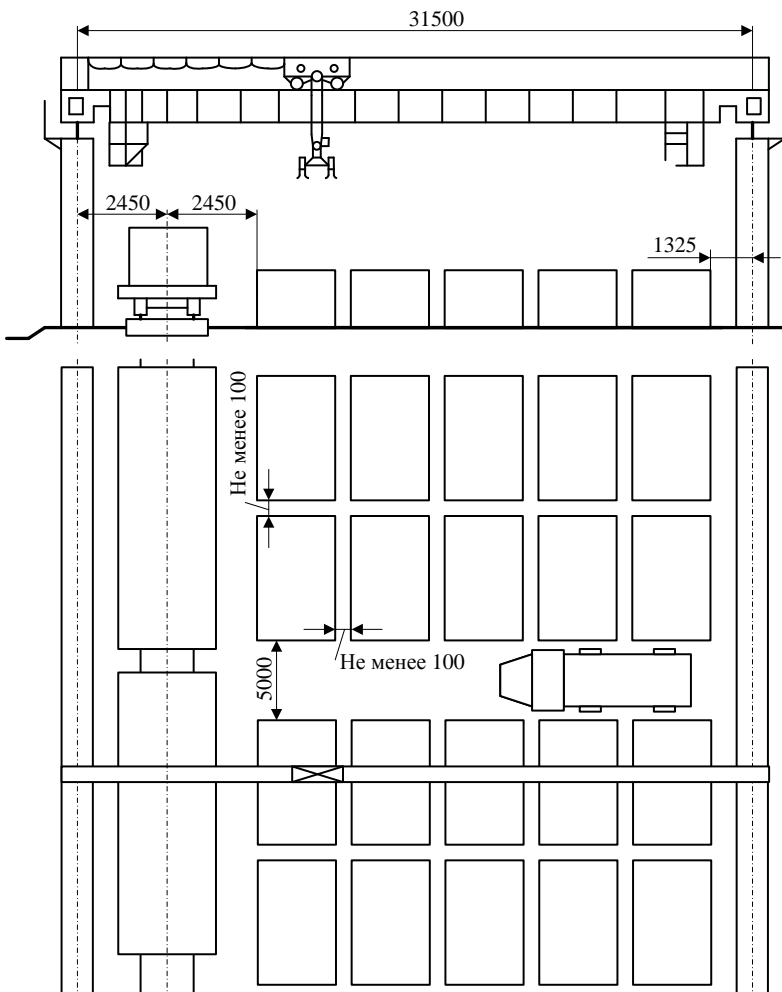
Схема механизированной перегрузки крепнотоннажных контейнеров с использованием мостового крана
